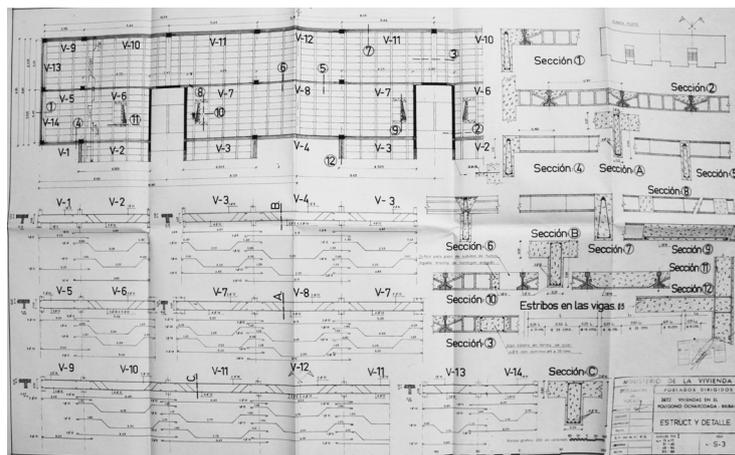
Planto Estructura y Detalle. Exp. 60-5-31. Sign. C-031305/008. TIPO I.
